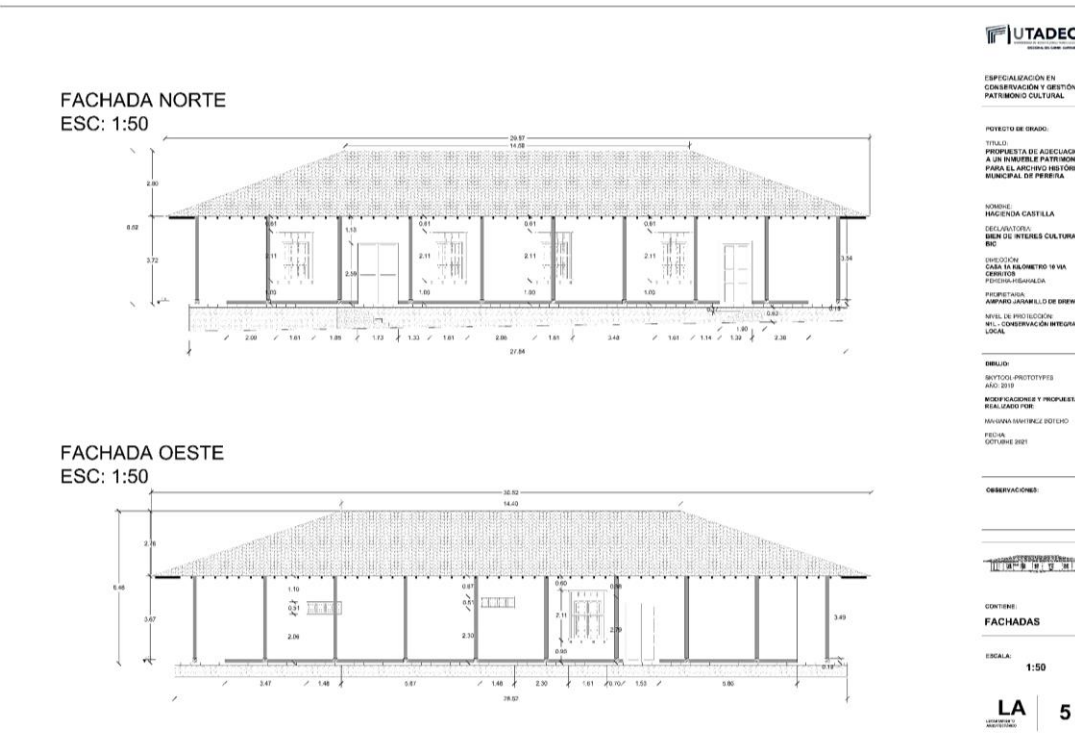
Levantamiento arquitectónico- Fachadas Casa principal. Fuente: Propia
